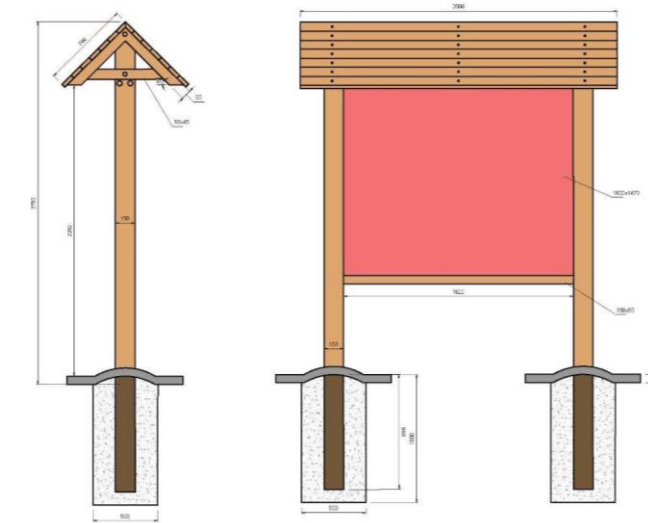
Panel informativo con tejadillo CN-00 (detalles en plano 12.1)
